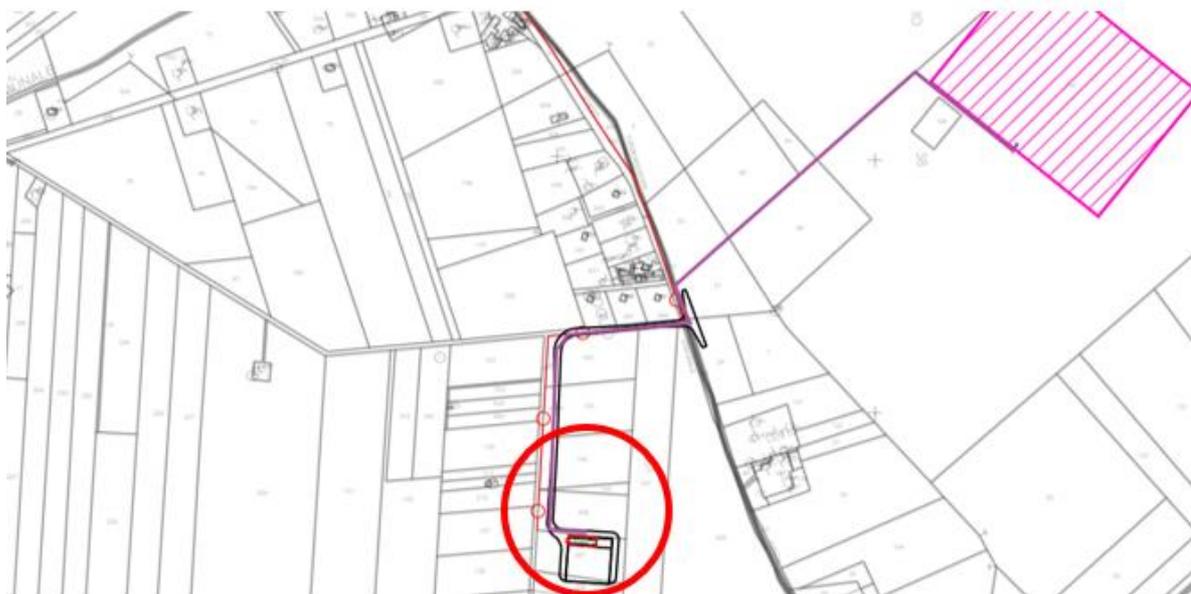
Localizzazione area di cantiere presso area sottostazione di collegamento, 150/30 kV, stralcio Tavola Planimetrie aree di cantiere del Progetto definitivo, – Codice Elaborato G.8
